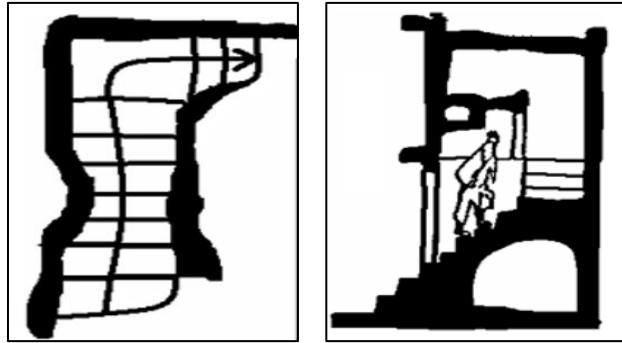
plan et coup sur l'Escalier à l'intérieur de la maison.
